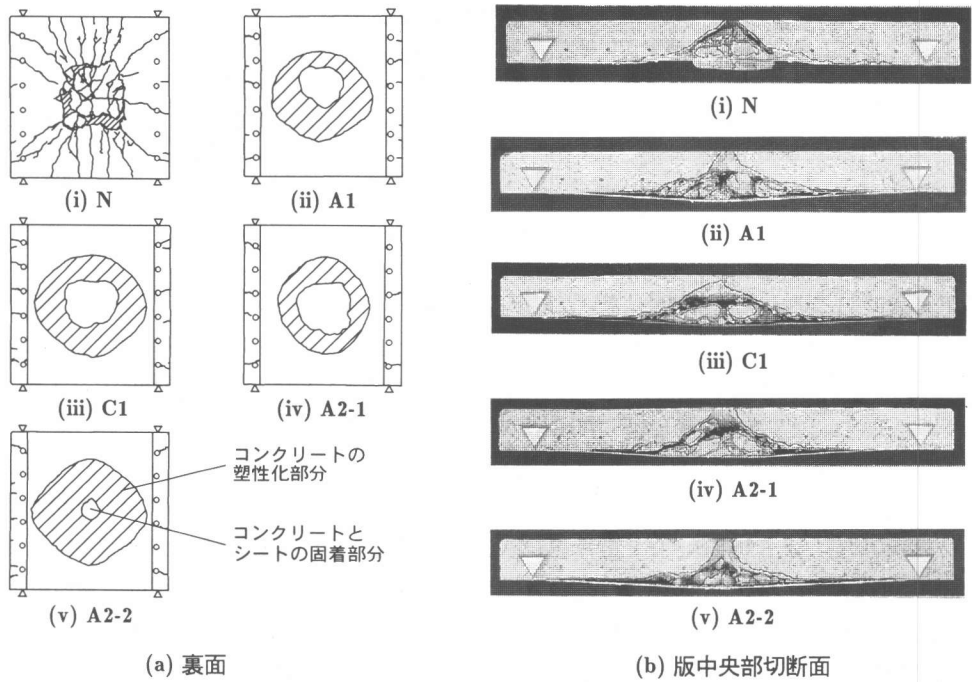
実験終了後の RC 版裏面および版中央部切断面のひび割れ性状
